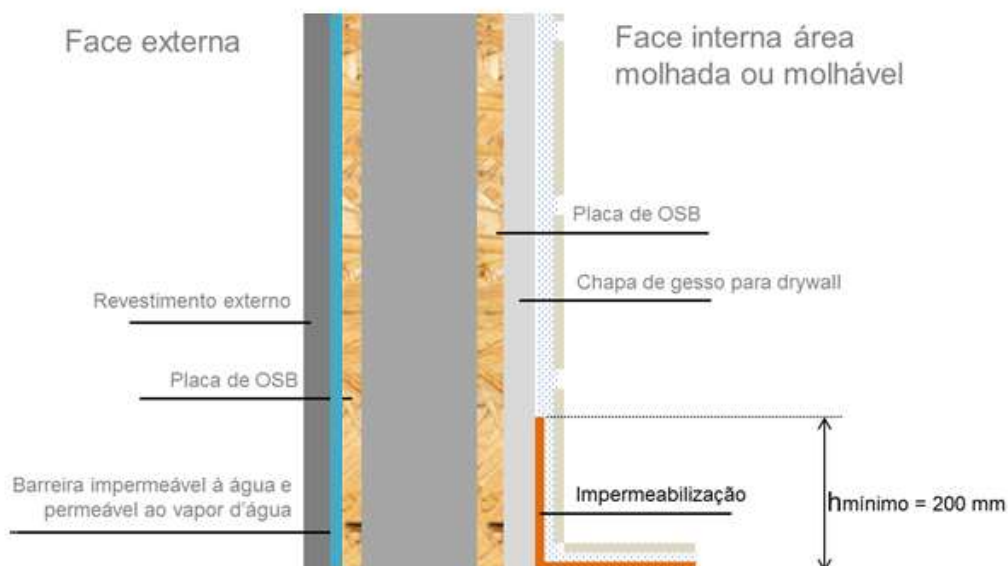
Corte esquemático de um Sistema de Vedação Vertical Externo para ilustração da impermeabilização
